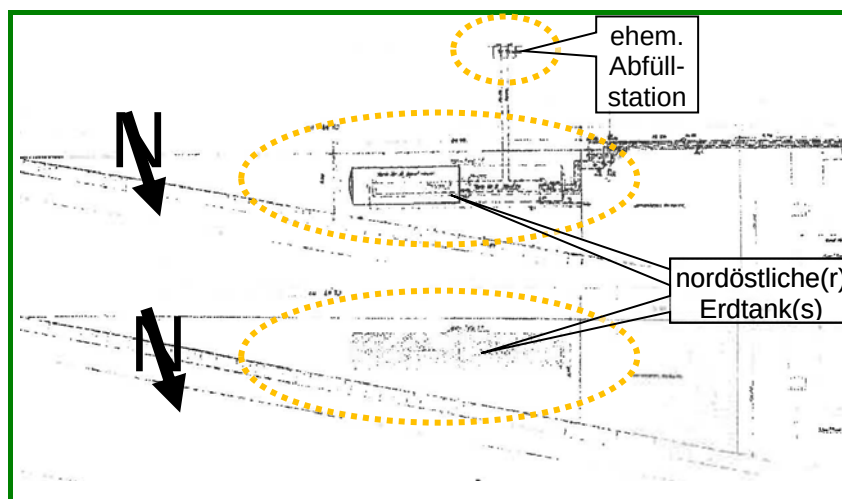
2 Plan-Ausschnitte: Erdtank(s) im nordöstlichen Bereich (Altpläne)
